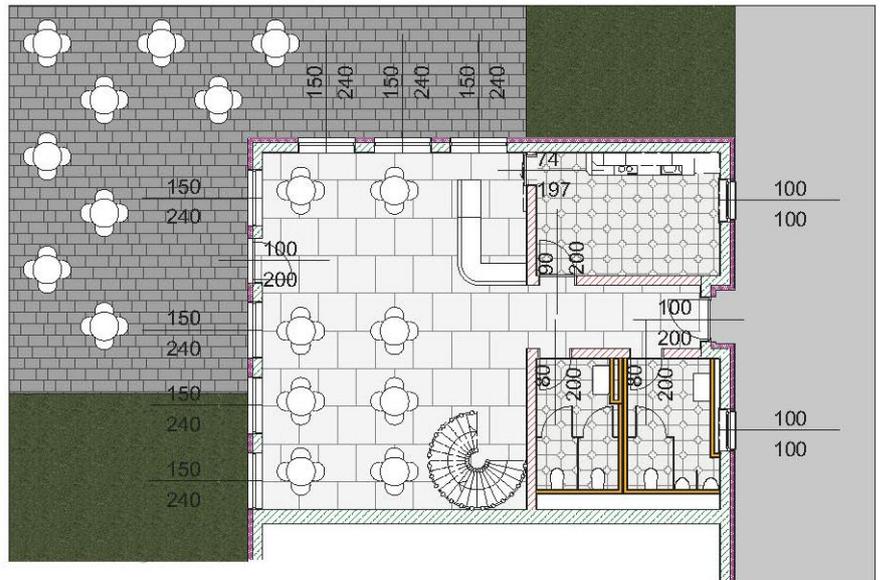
| Grundrisse Café Maßstab 1:200
